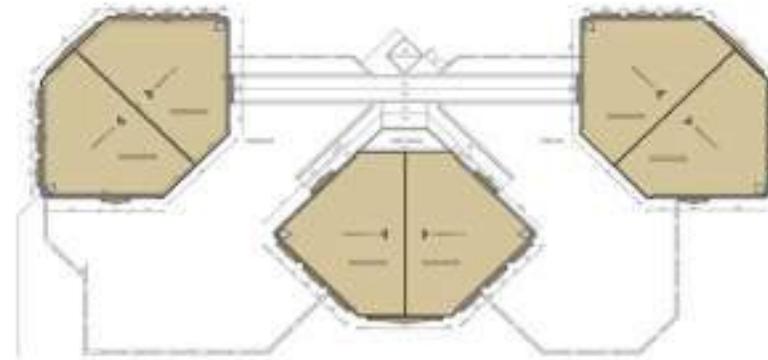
Planta de cubierta superficies que requieren impermeabilización
